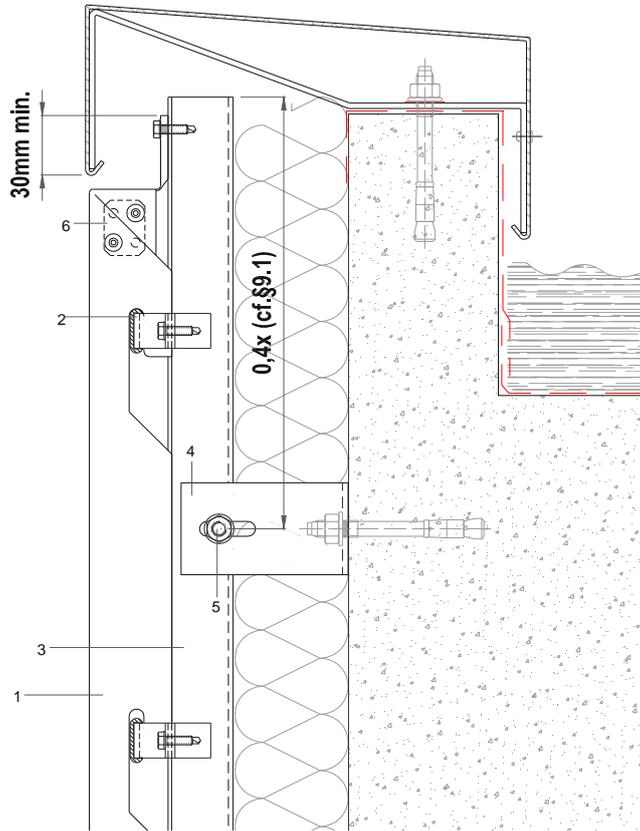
Acrotère – Coupe Verticale – Mise en œuvre avec profilé LCH-1
